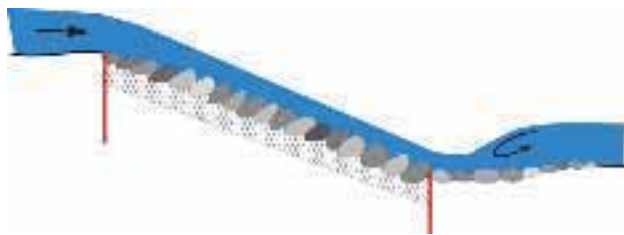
Rampendeckwerk in Setzsteinbauweise.
